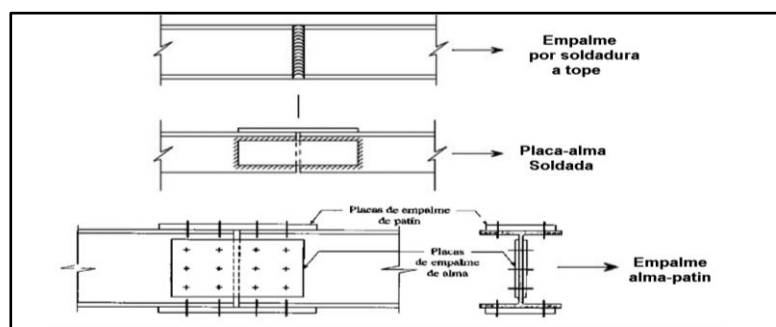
Tipos de empalmes en vigas y columnas. Vinnakota (2006)
